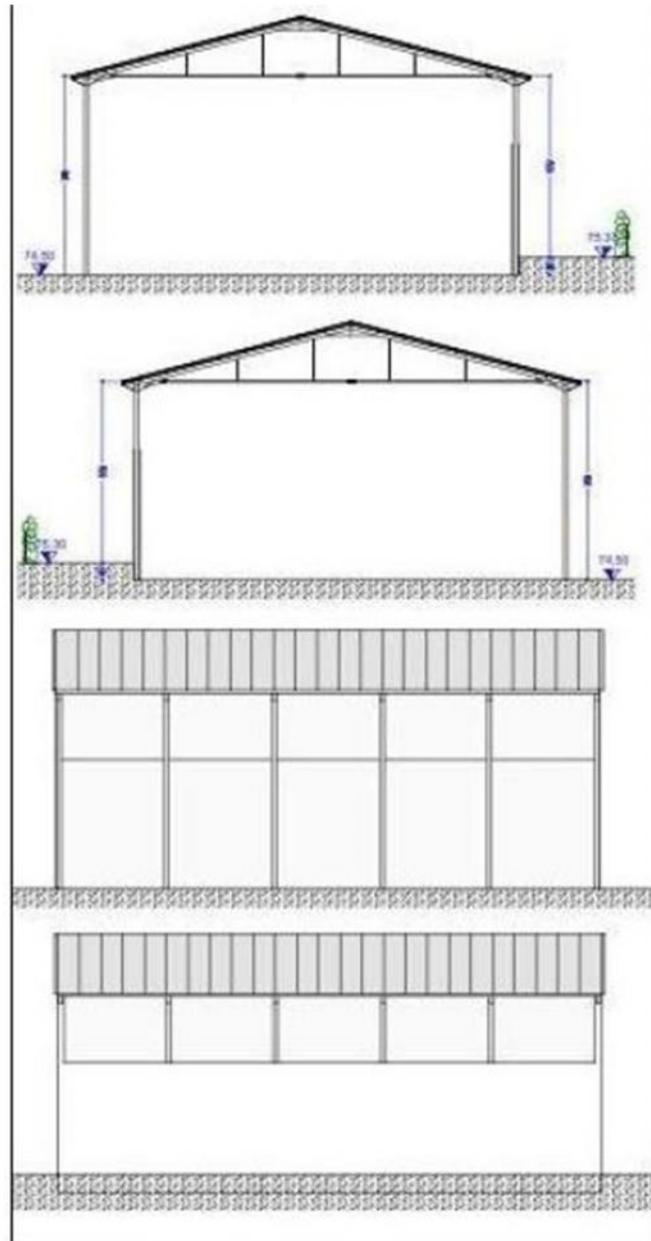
Prospetti del capannone – estratto di progetto TAV.3 (in ordine: prospetto SUD EST, NORD OVEST, SUD OVEST, NORD EST)
